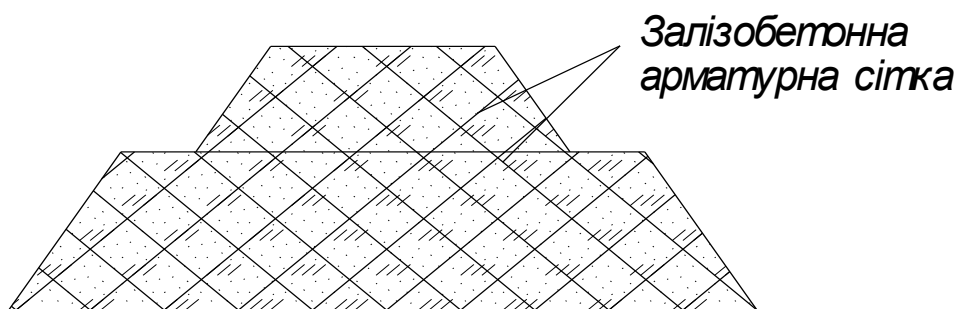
Екранування відвалу залізобетонною сіткою
